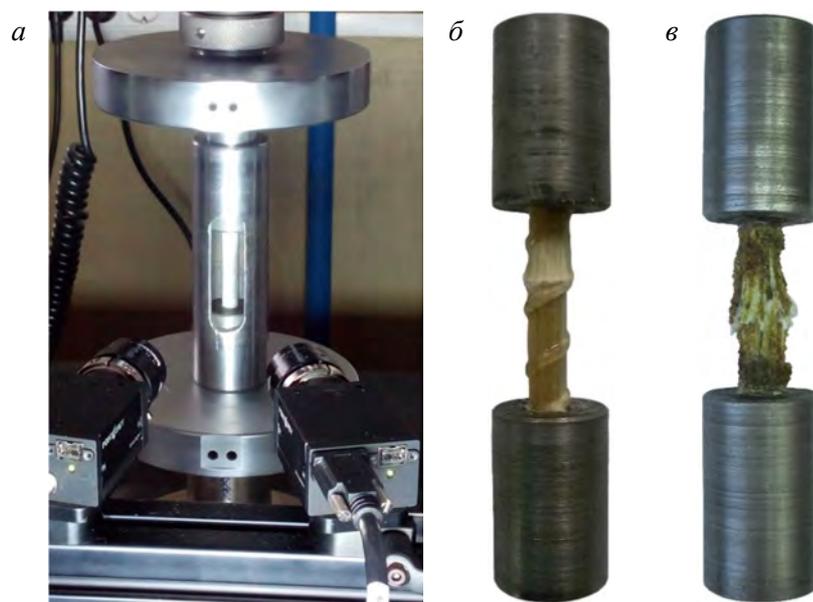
Испытание композитных стержней на осевое сжатие: общий вид испытания (а); характерные схемы разрушения АСК (б) и АУК (в) при сжатии
